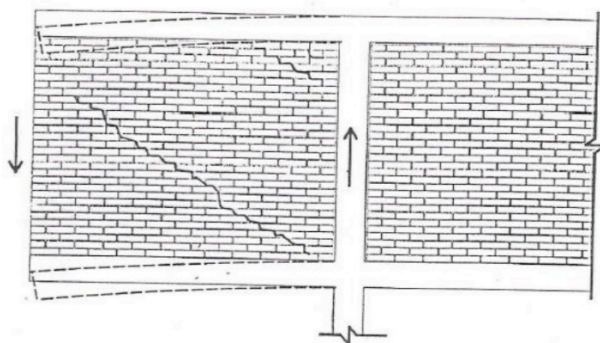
Configuração das trincas na alvenaria devido ao cisalhamento e à deformação excessiva de vigas em balanço. (Silva e Jonov)
